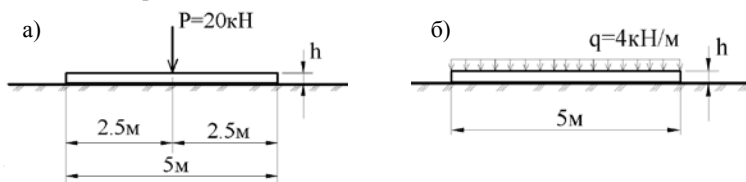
Розрахункові схеми балок на ґрунтовій основі:
